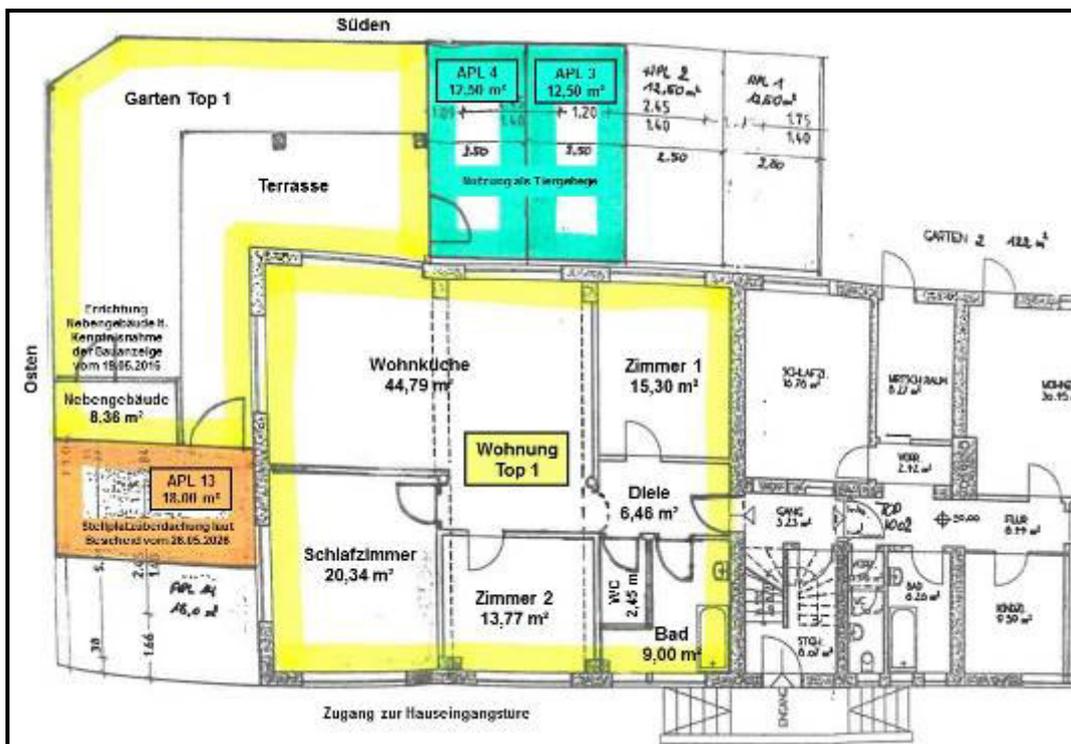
Grundriss Wohnung Top 1 und Abstellplätze Top APL 3, 4 und 13
